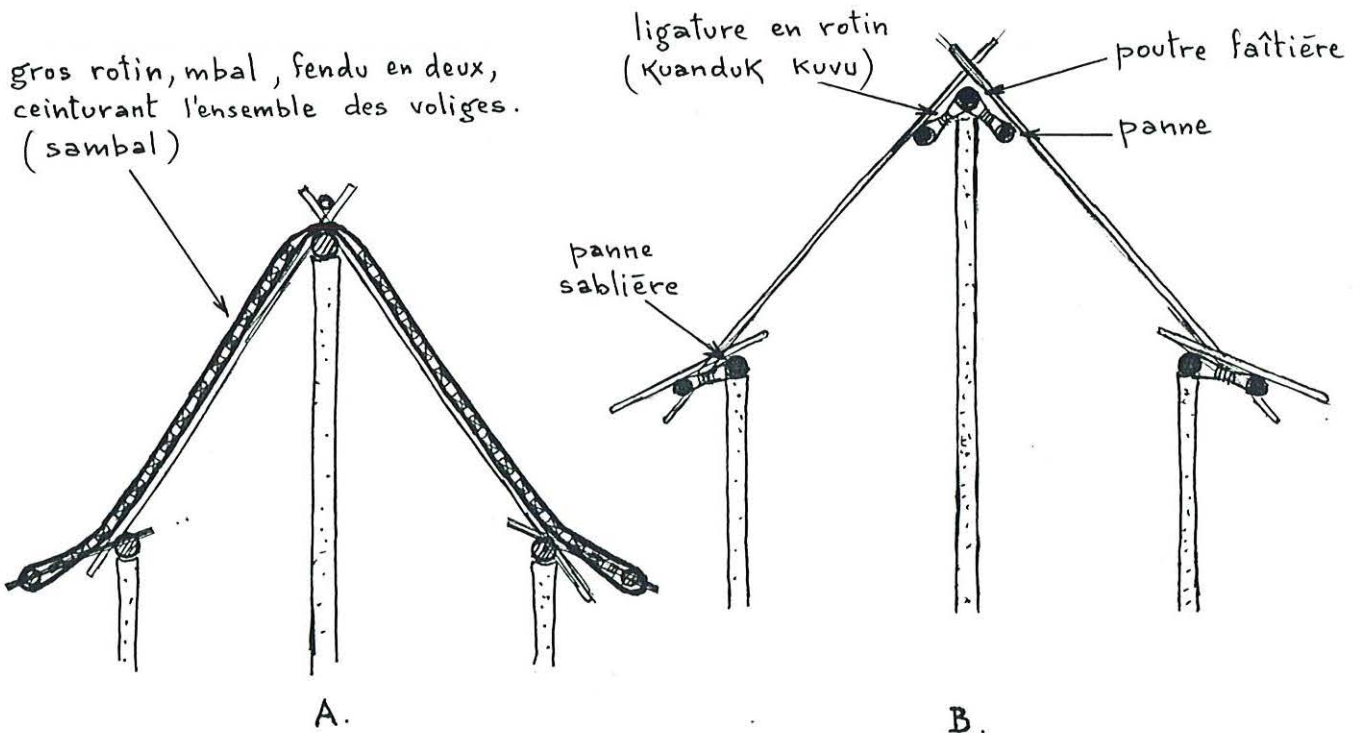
(A & B) - Liaisons entre poutre faîtière et poutres sablières (A). Système de fixation autour de la poutre faîtière et des poutres sablières (B).
